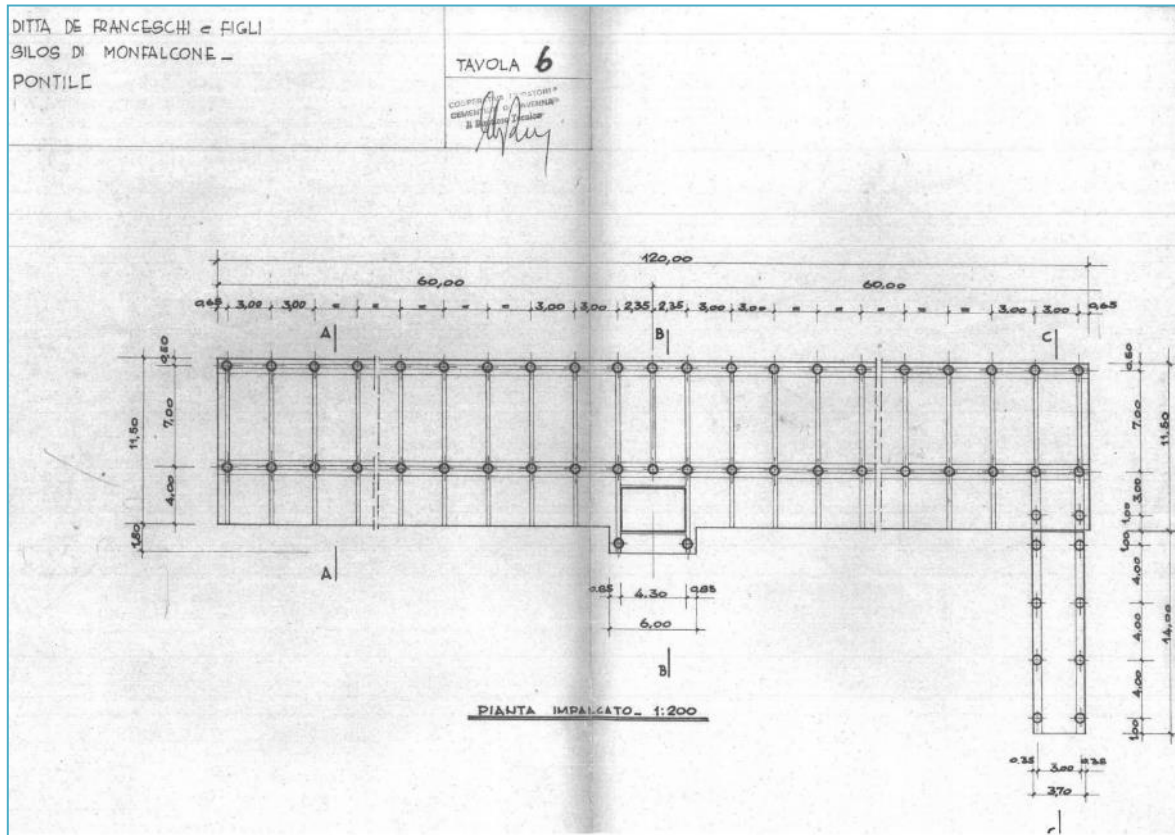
Pianta dell'impalcato esistente (tratta da progetto originale 1968)
